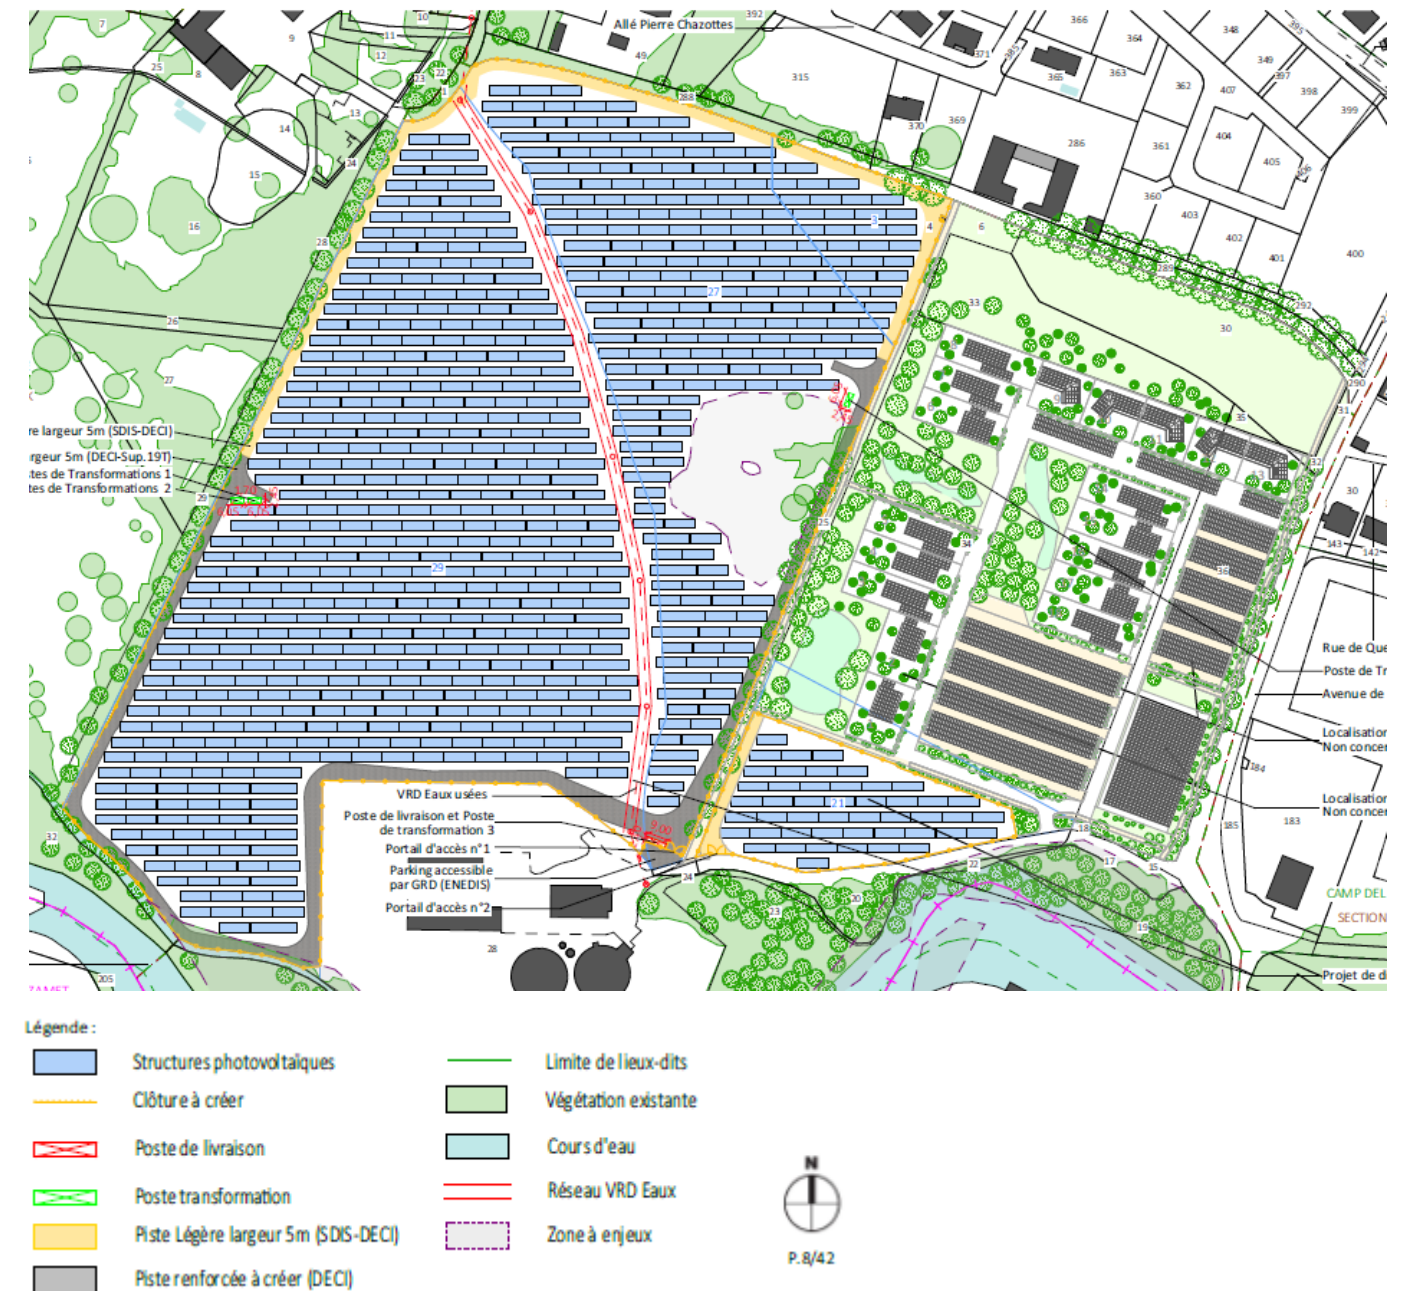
Plan de masse de avril 2023 (source : Watt&Co Ingénierie)
